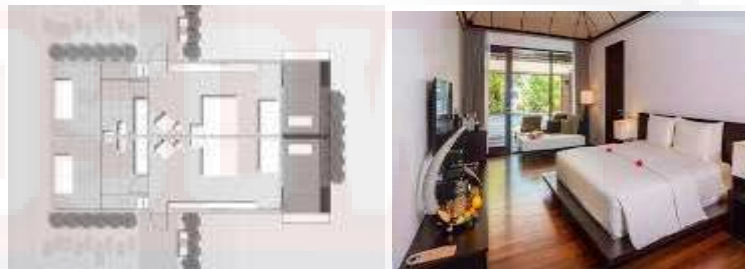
Bentuk Denah Deluxe Water Villa
